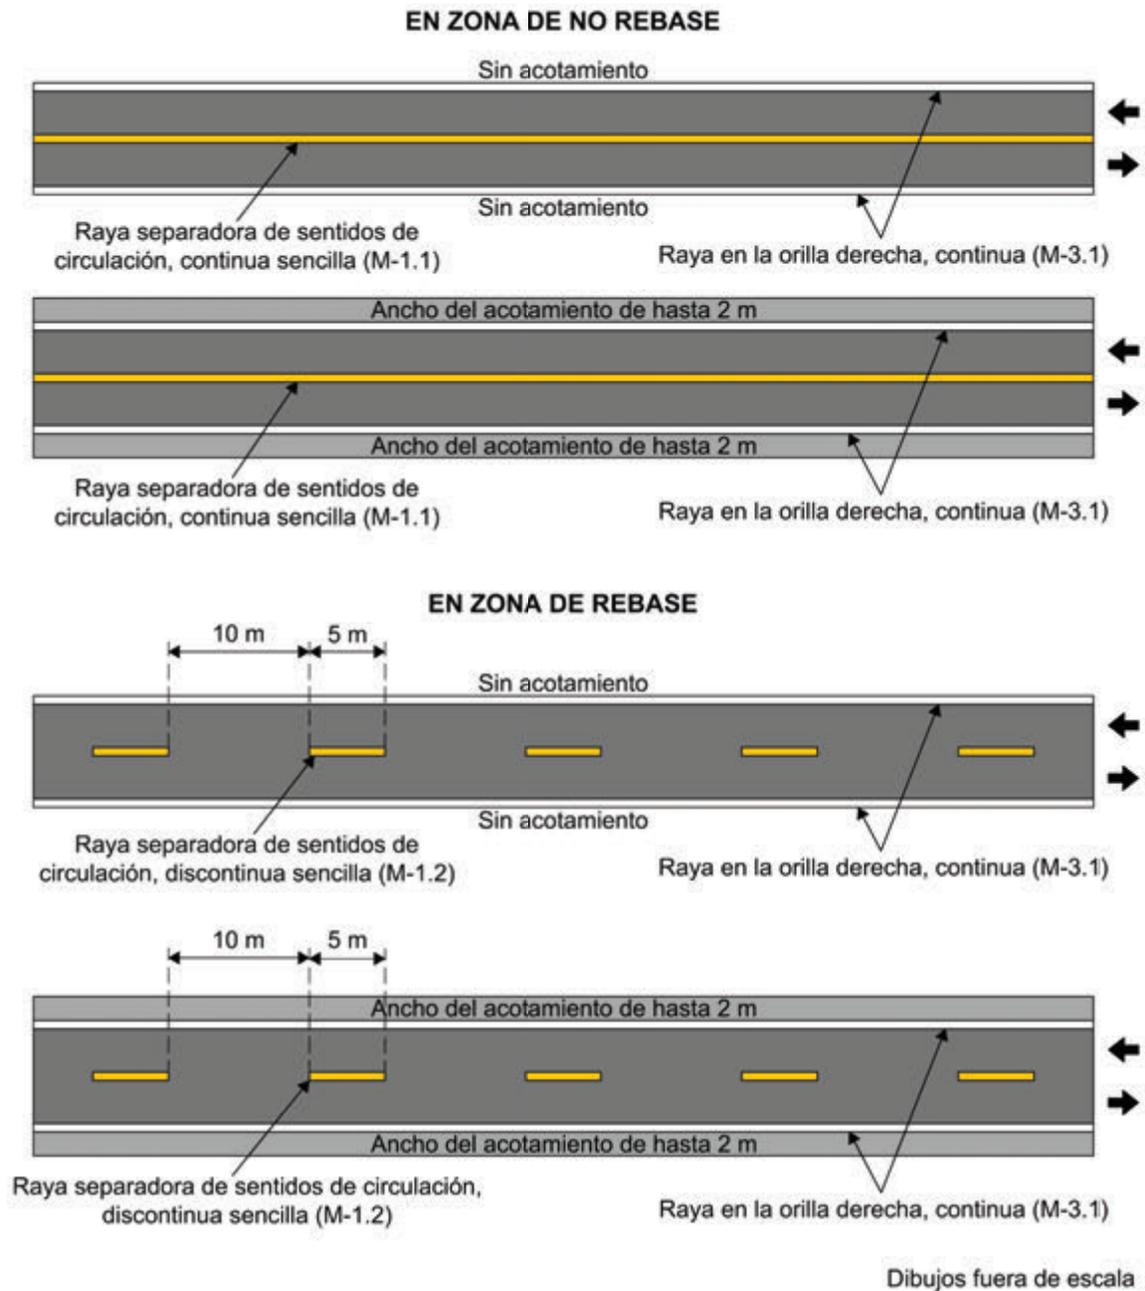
Marcas en el pavimento en carreteras con ancho de arroyo vial de hasta 6.5 m
